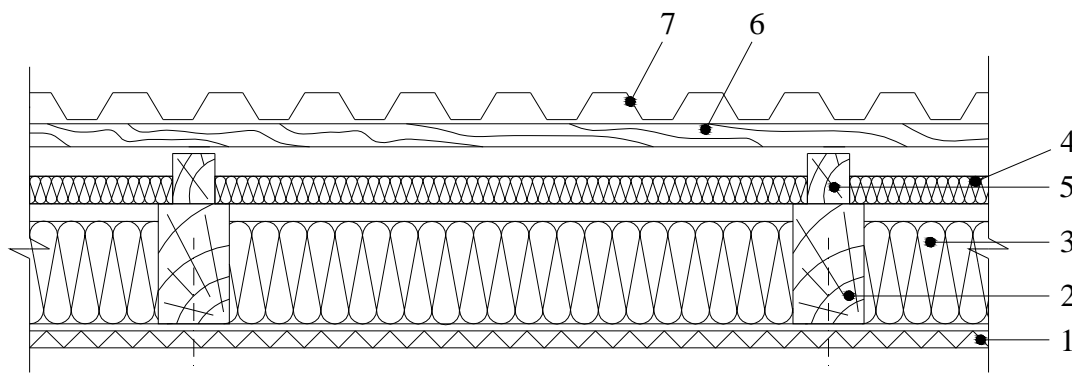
Вариант конструктивного решения устройства теплоизолирующего слоя. Утеплитель разделен на две части. Стропила изолированы сверху:
